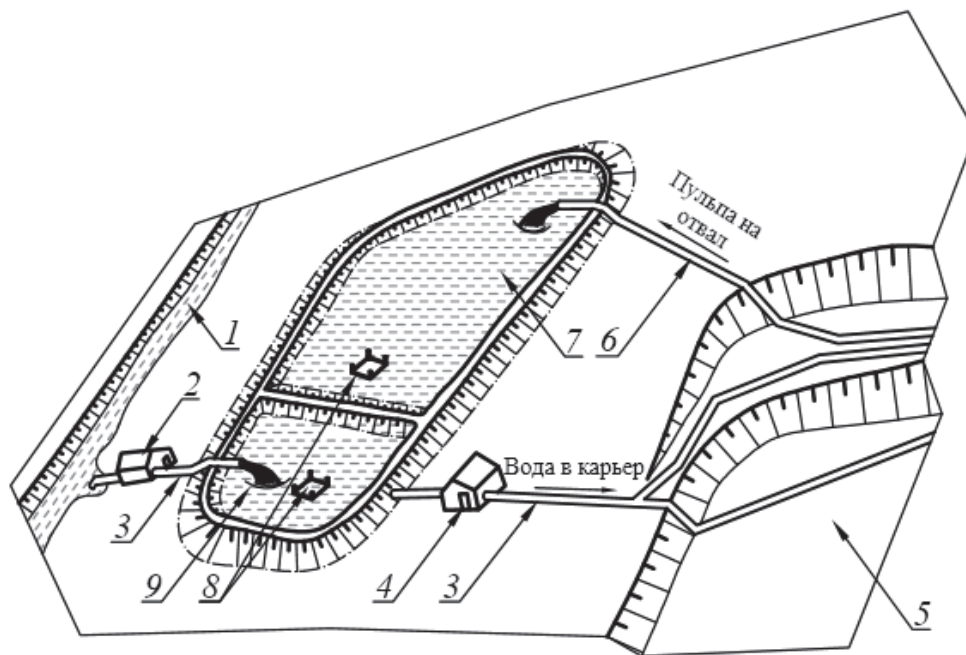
Схема водоснабжения (по Г. А. Нуроку): 1 – река; 2 – насосная станция подпитки; 3 – водовод; 4 – насосная станция; 5 – карьер; 6 – пульповод; 7 – гидроотвал; 8 – водосбросный колодец; 9 – отстойник
